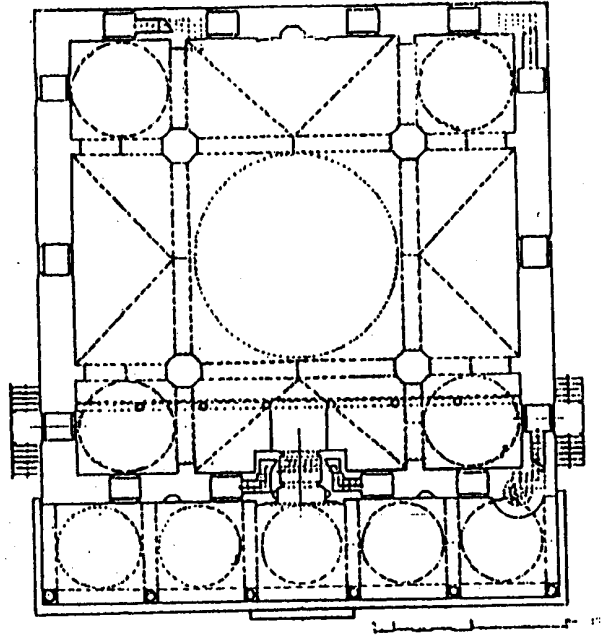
مسقط أفقي لجامع الوالدة الجديدة بإستانبول (عن : Gabriel)
